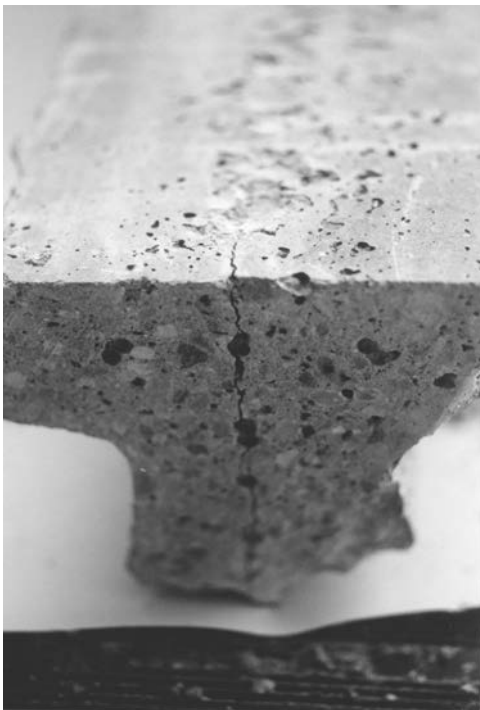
Vigueta de hormigón pretensado agrietada longitudinalmente durante la transferencia de la fuerza de pretensado.
